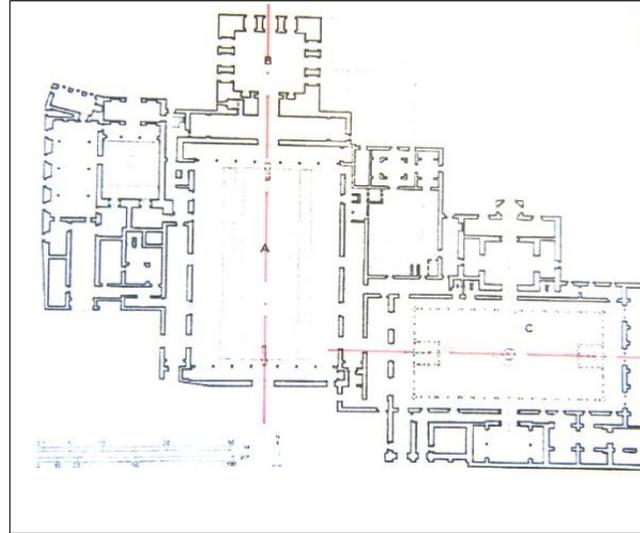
Plan du palais de l'Alhambra (Grenade)
